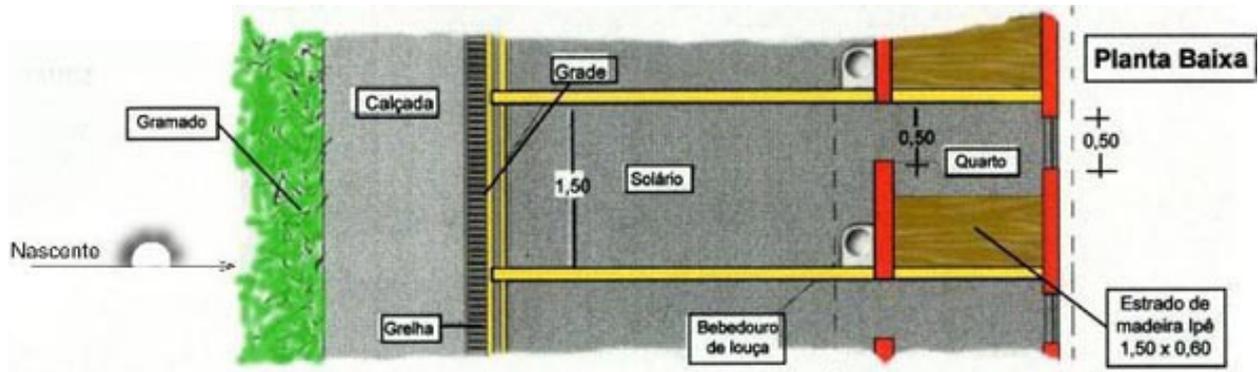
Croquis esquemático da Planta Baixa - Canil ideal. Fonte: Web Animal, 2016.
